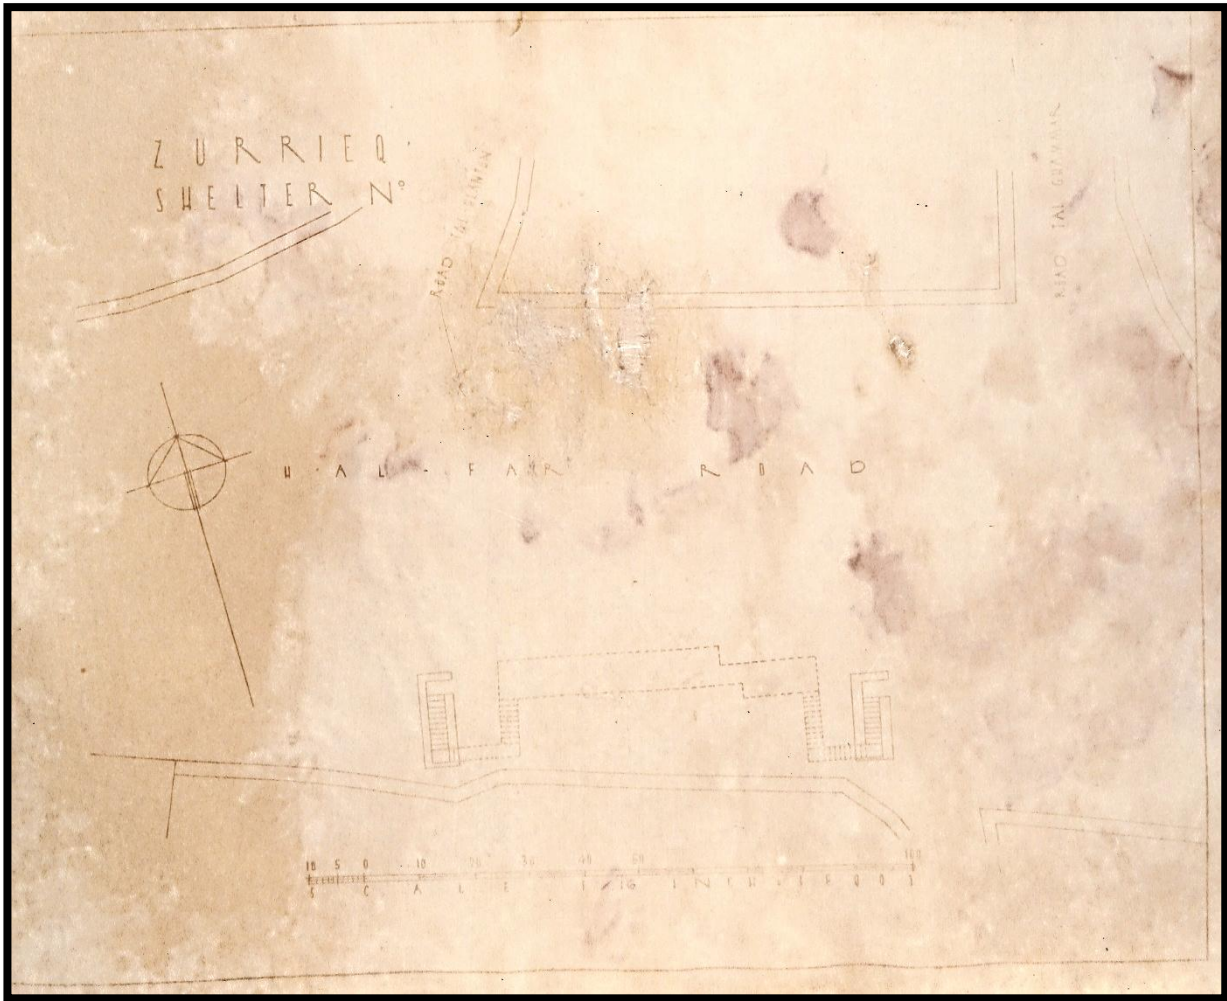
Planta do Abrigo "Road Tal-Hanium* – Hal -Far – Road"
